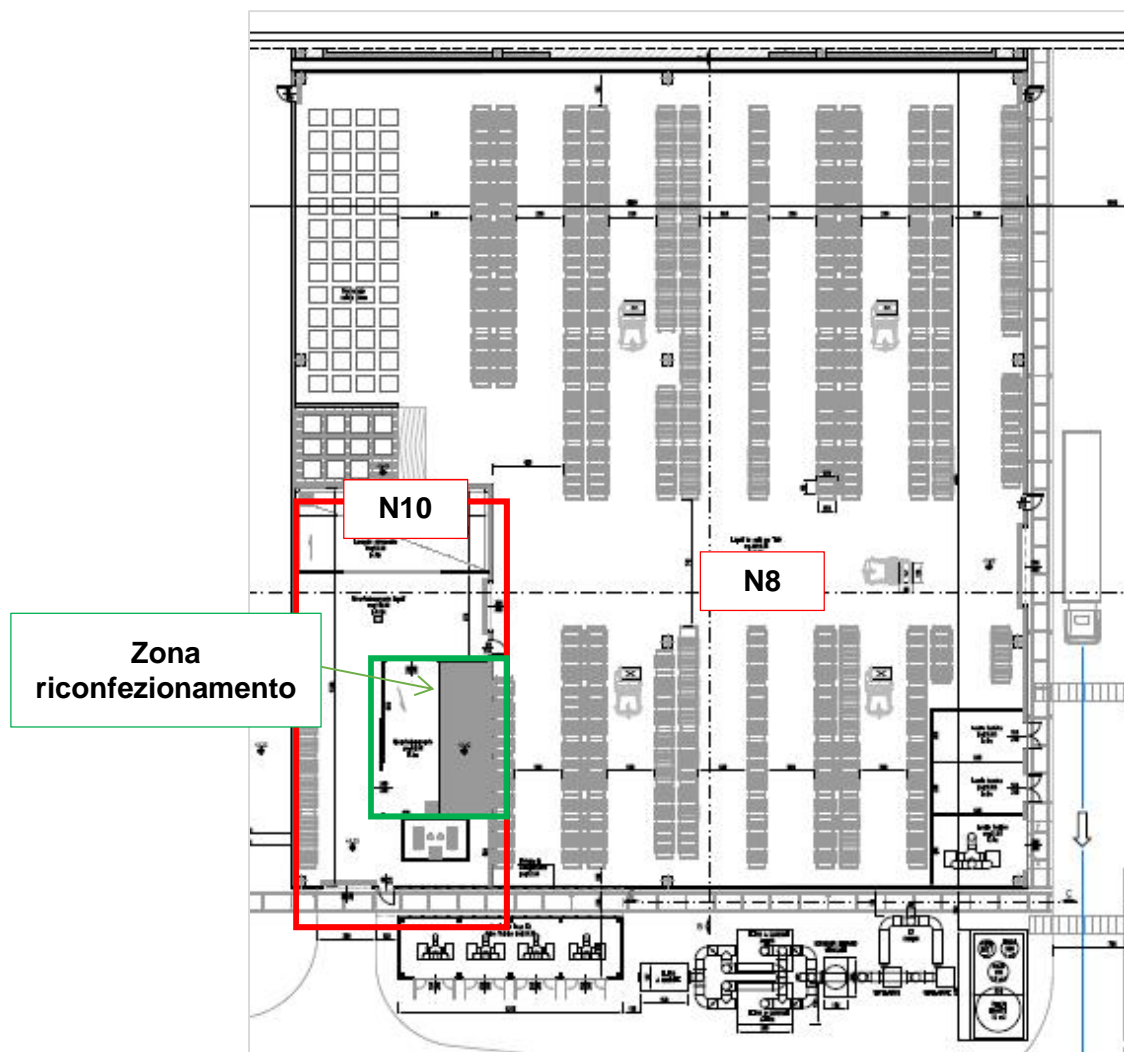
Dettaglio localizzazione Sezione N10 (stralcio elaborato EI.48.00_CO 05 RA VA 00 D1 PL 48.00 - N8-N10 PIANTE)
